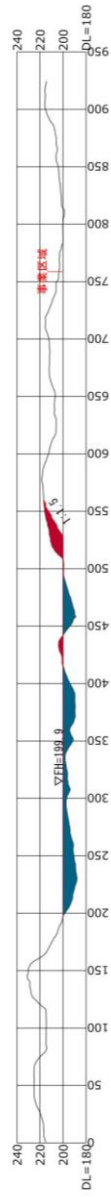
(2) 切土・盛土計画断面図 (E2-E2' 断面)
